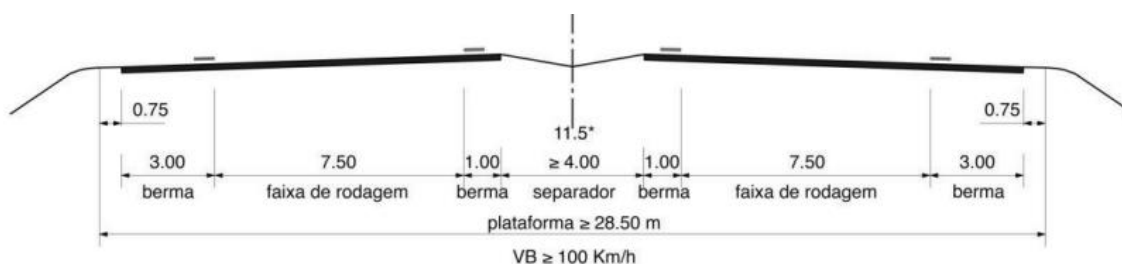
Perfil Transversal Tipo de Autoestrada [19]
